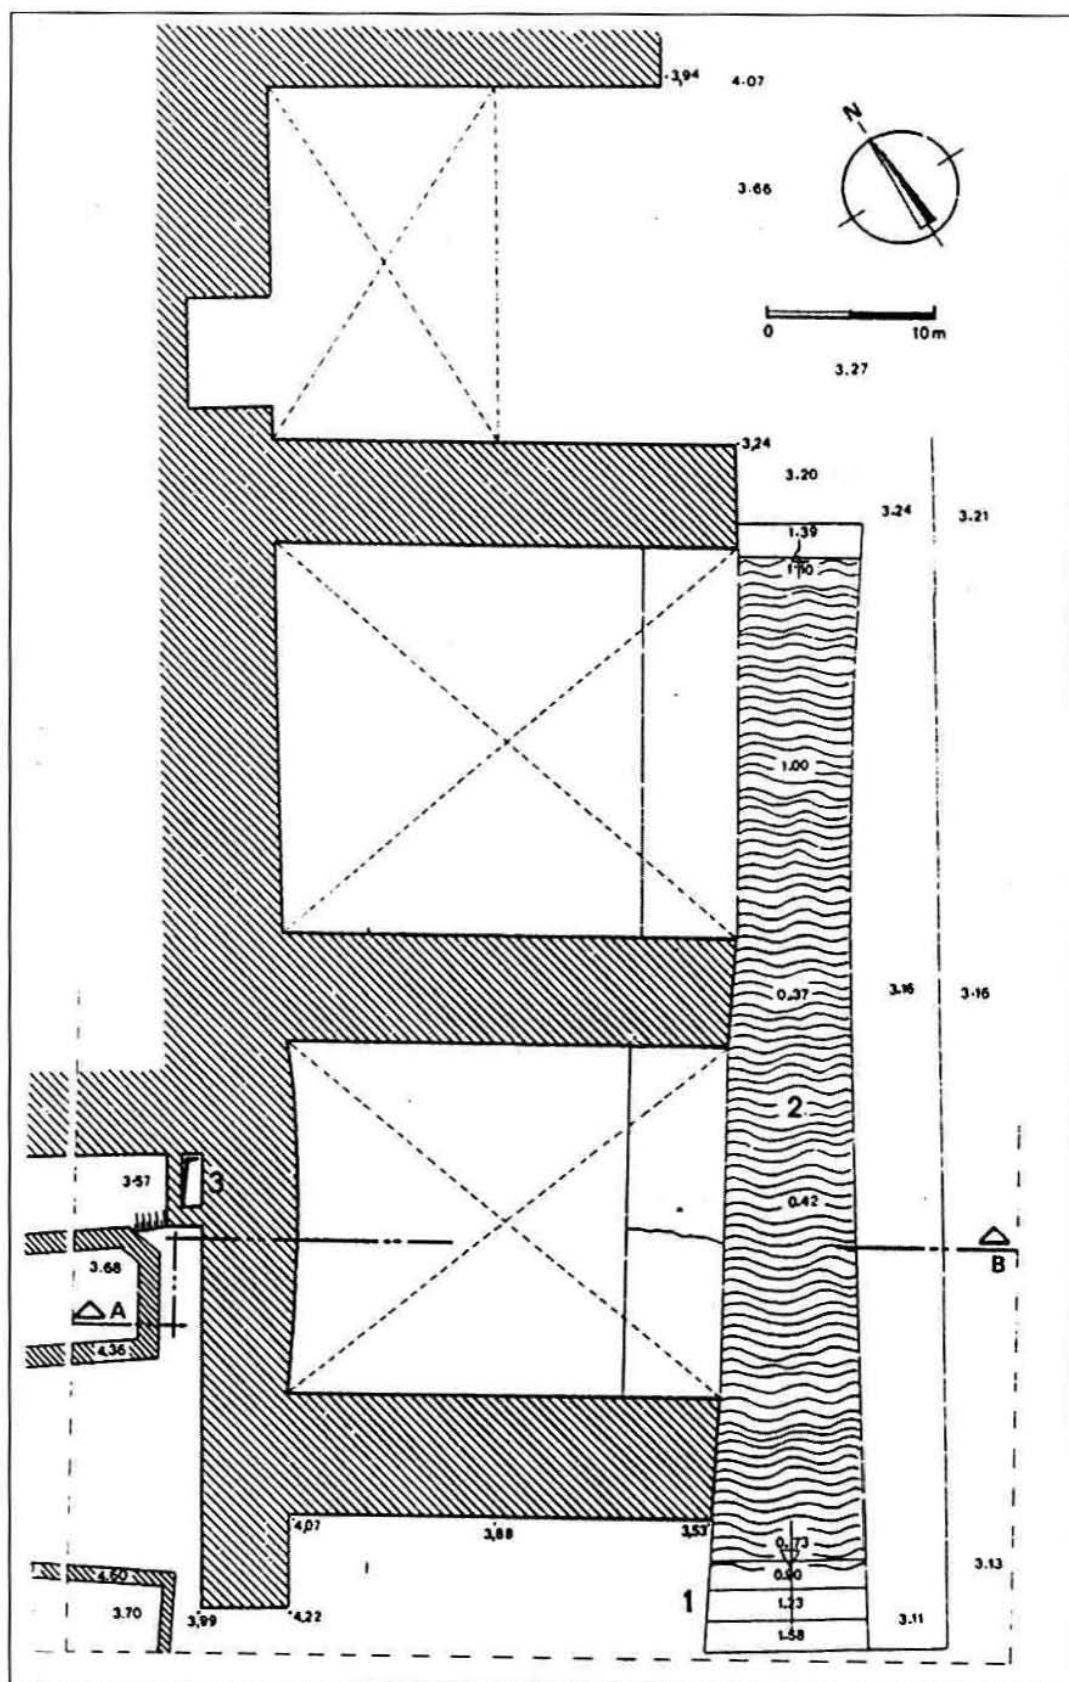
Instalação hidráulica de Tróia. Corte horizontal (1 – escada do poço; 2 – poço; 3 – caleira)
